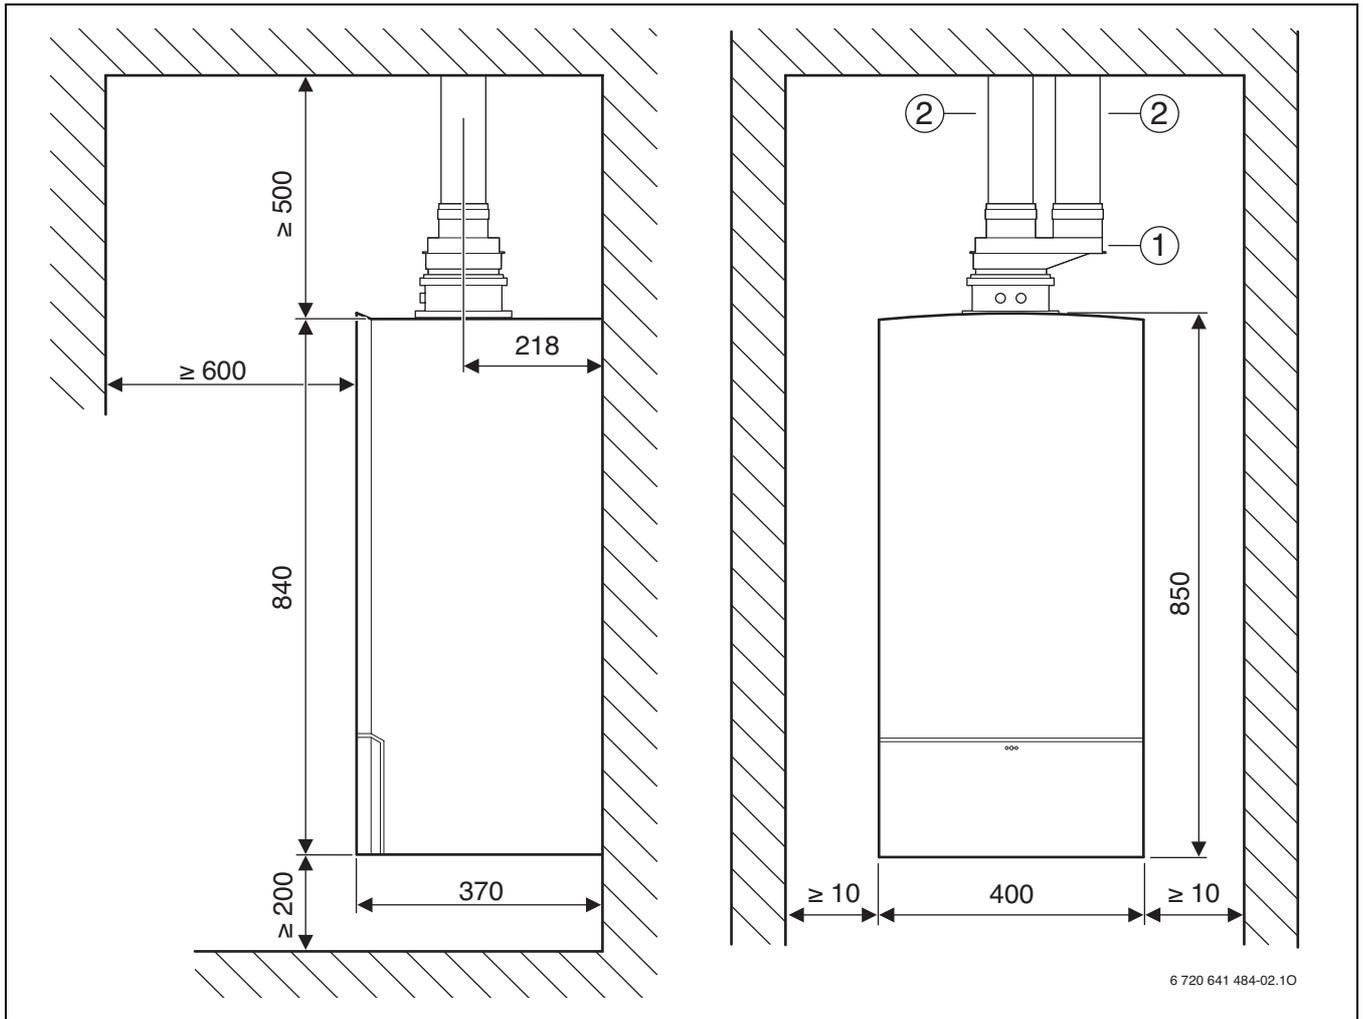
Salida paralela Ø 80/80 mm, techo plano
